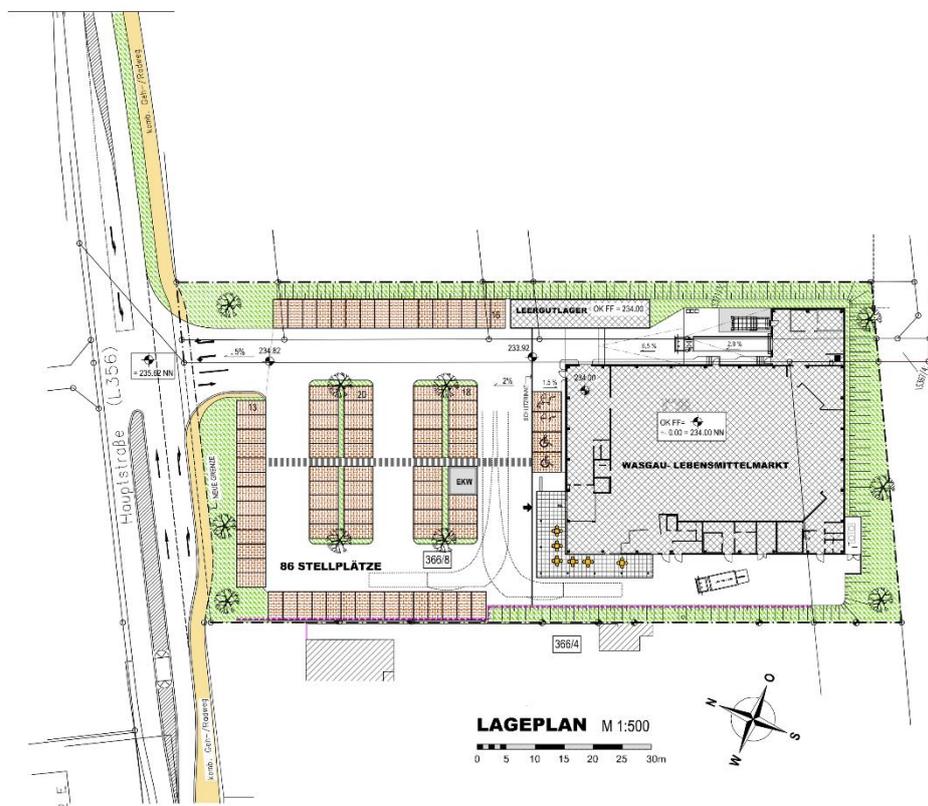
Lageplan Architekturbüro Richard Krämer, St. Ingbert
